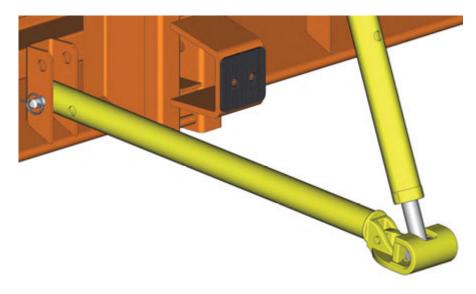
DETAILS DE FIXATION DES ACCESSOIRES SUR MINI BANCHE 1500
